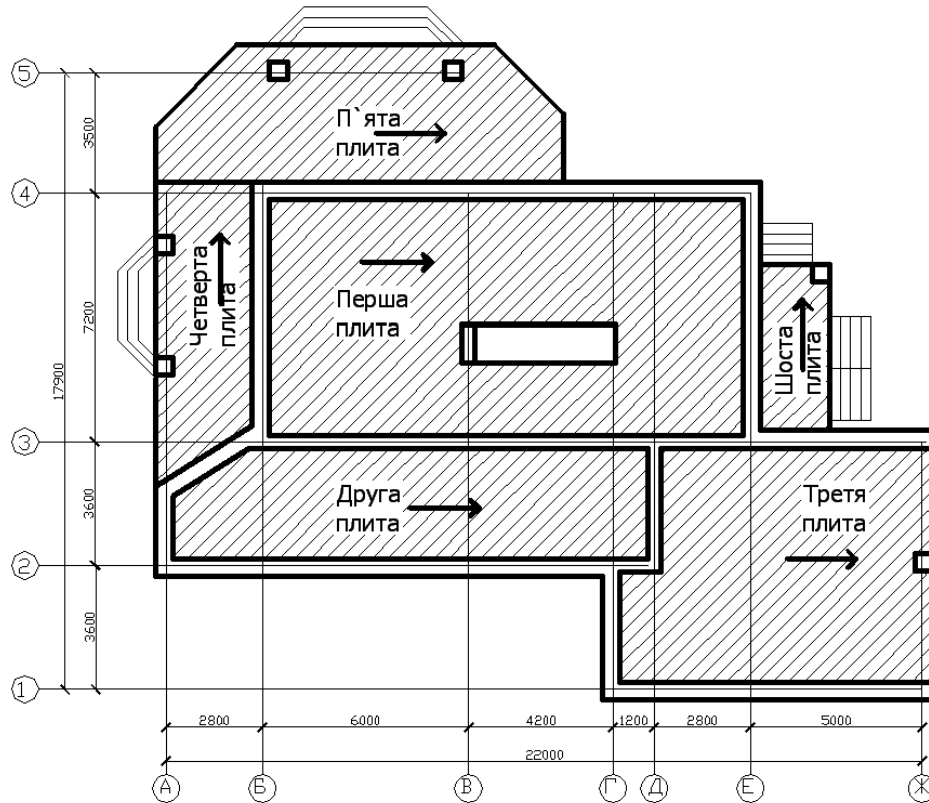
Схема виконання монолітного залізобетонного перекриття
